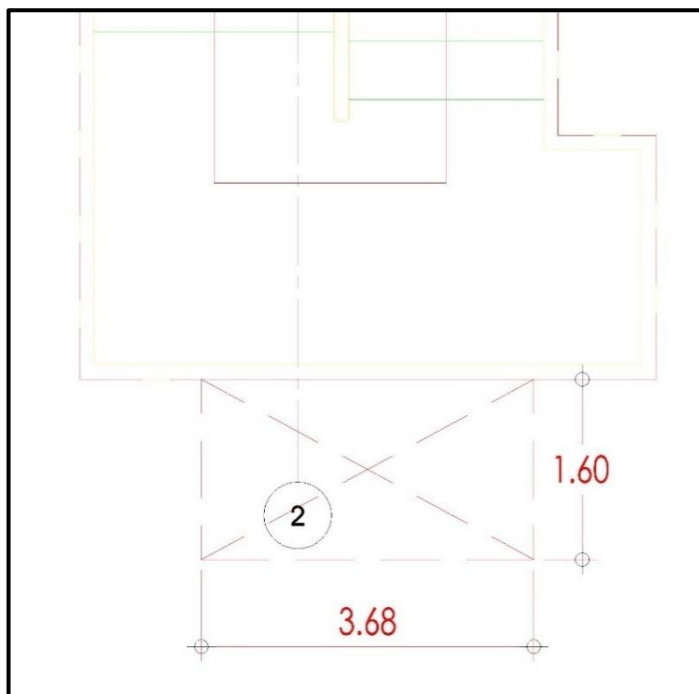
Localización Planta Ascensor Punto Fijo Bloque C-1, Hernández y Ramírez 2024.
